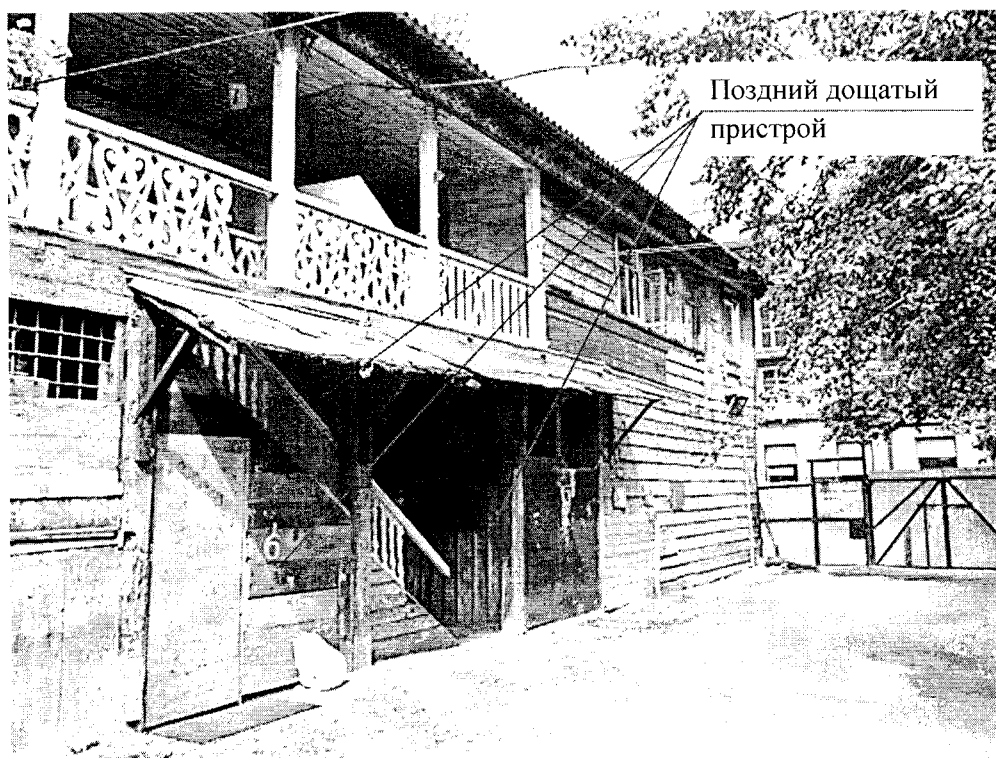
Фрагмент продольного, дворового (северо-восточного) фасада жилого дома (лит. А)
